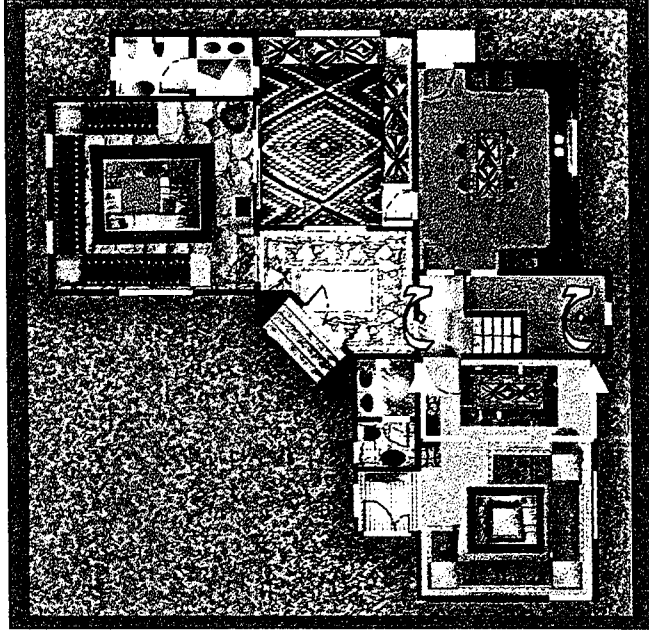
/١٢٠) مسقط أفقي يبين الدور الأرضي والقطاع المحدد عليه (ب / ب)
